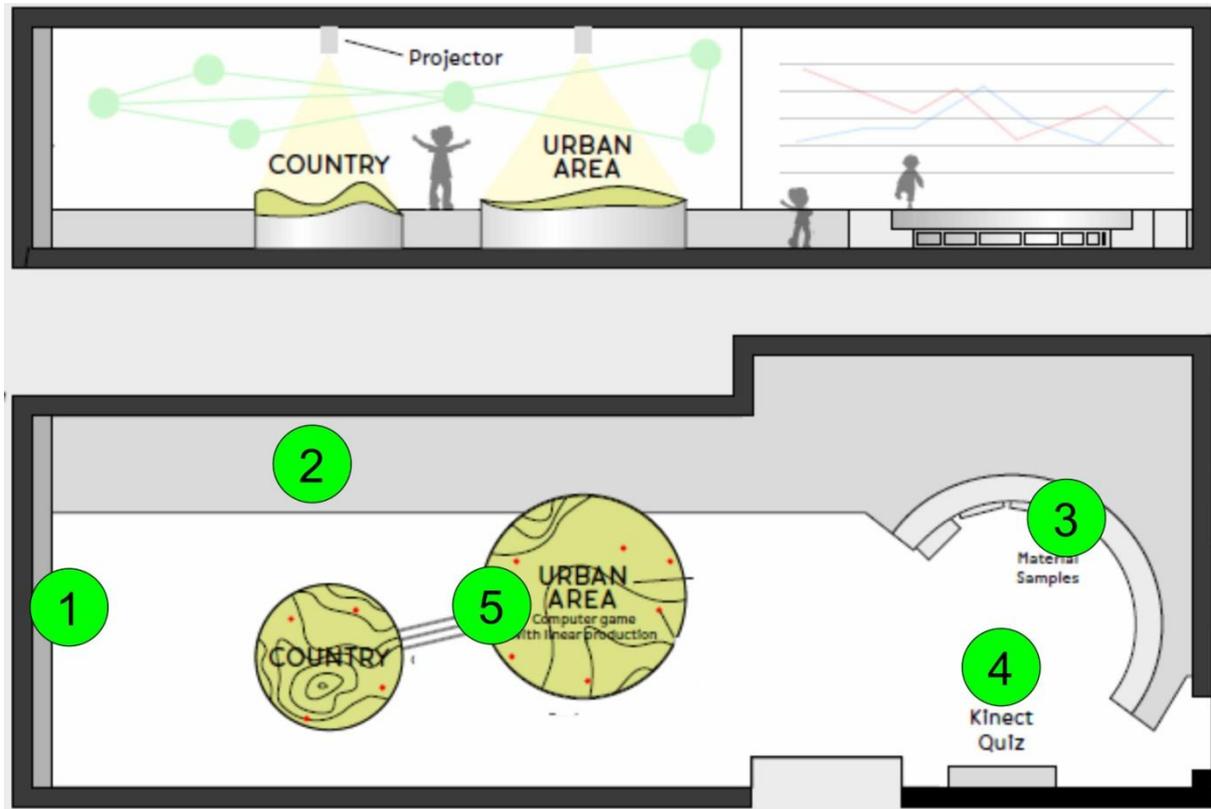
Grundriss und Stationsübersicht südlicher Flügel
